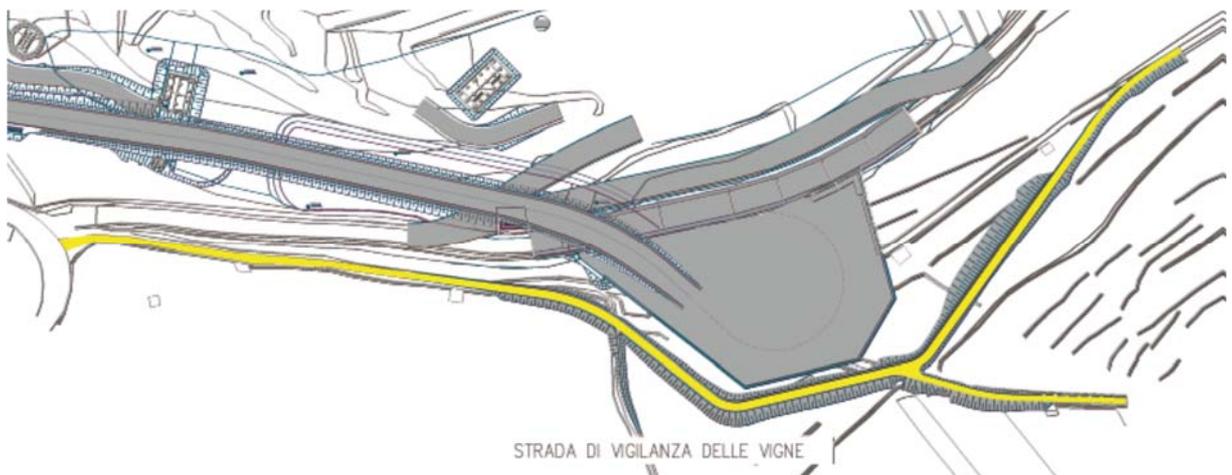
Modifica strada delle Vigne ad uso FFO per la realizzazione del Piazzale
